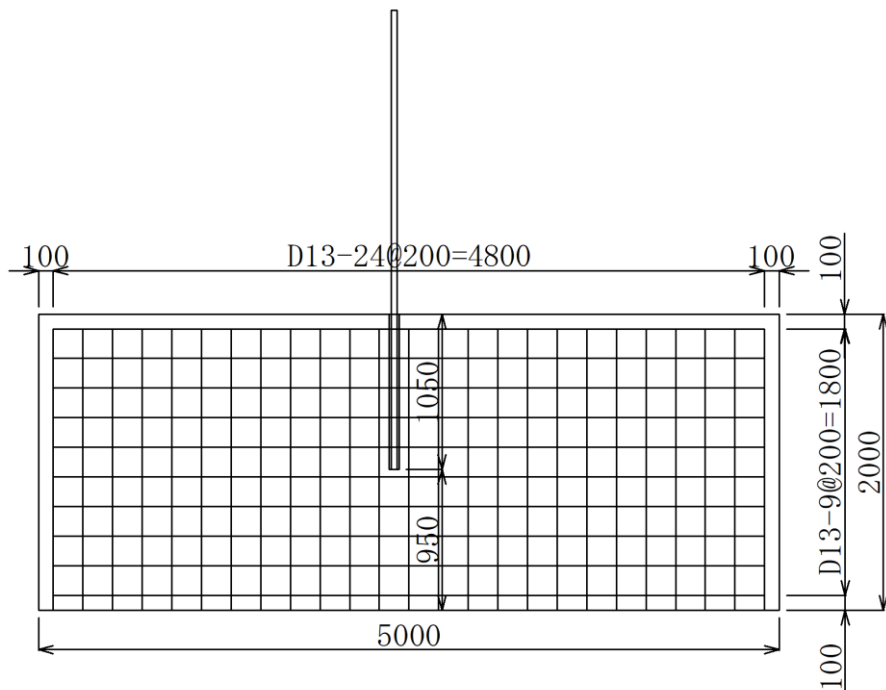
(8) 実験体②の配筋図 (C-C 断面図)
